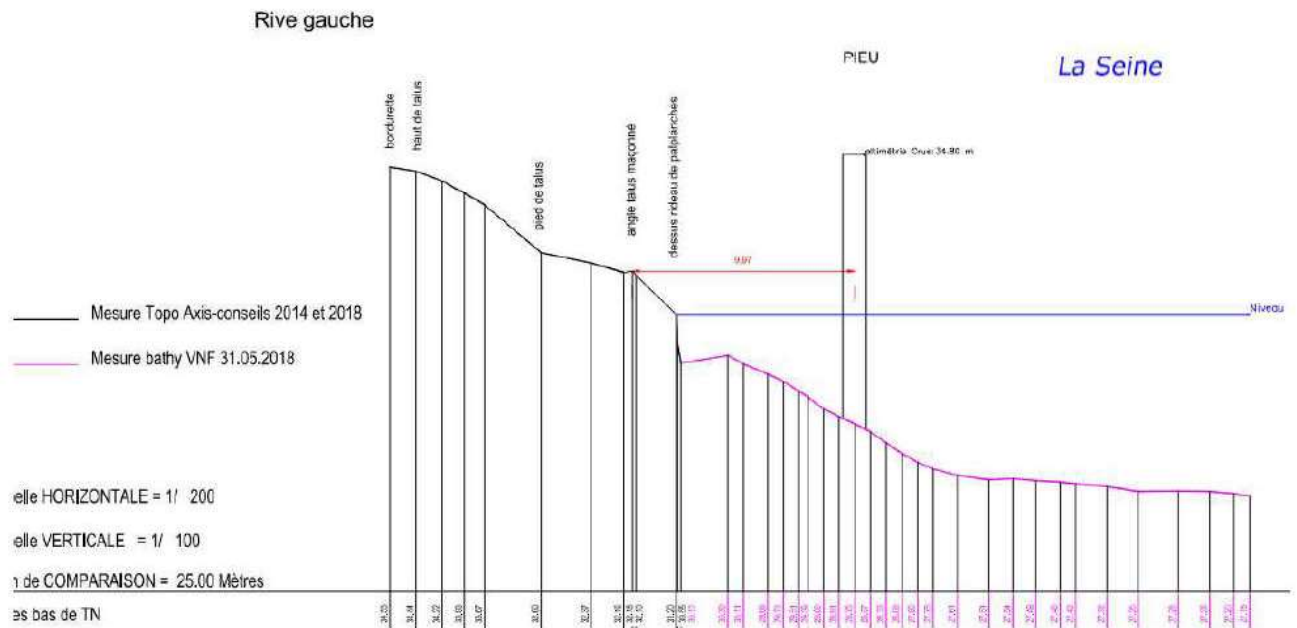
Coupe type de la berge au droit du projet d'implantation
